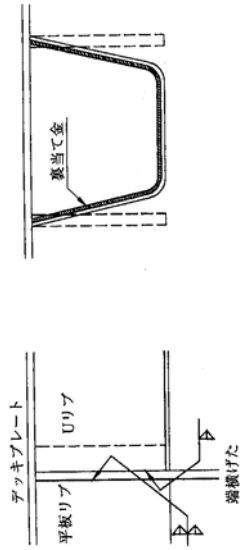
閉断面リブと端横リブまたは端横げたの交差部構造の標準
